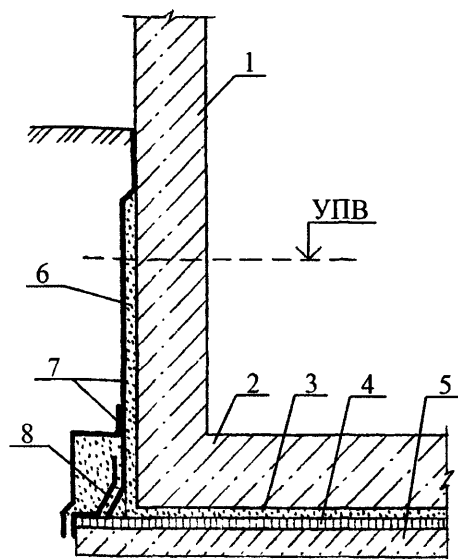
Штукатурная цементная гидроизоляция тоннеля при наличии подземных вод
